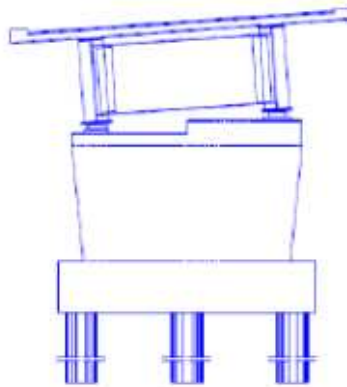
Progetto esecutivo, sezione trasversale tipologica pile
